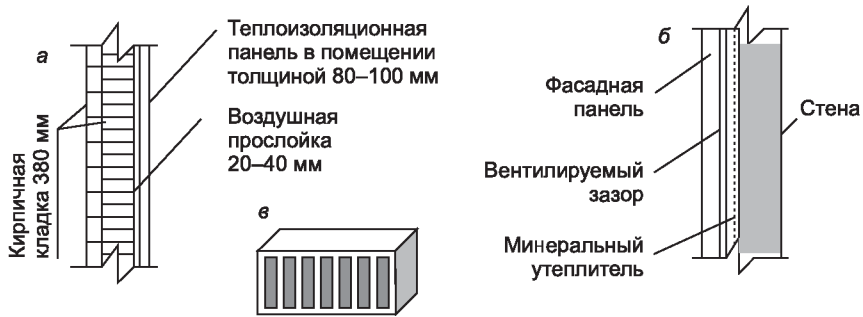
Облегченная кирпичная кладка (в плане) с теплоизоляционной панелью (а), вентилируемый фасад (б) и семищелевый керамический камень (в)
